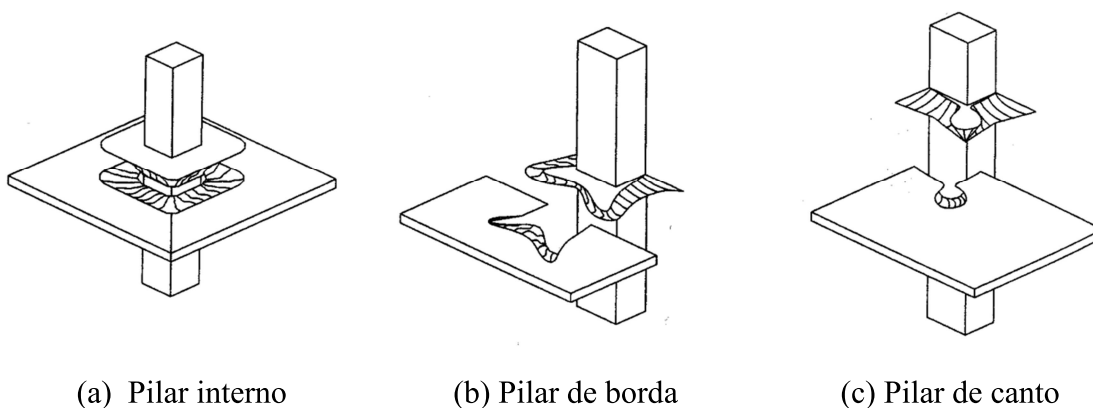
Perspectivas esquemáticas de superfície de ruína devidas à punção em ligações laje-pilar em lajes lisas (Carvalho, 2009)
